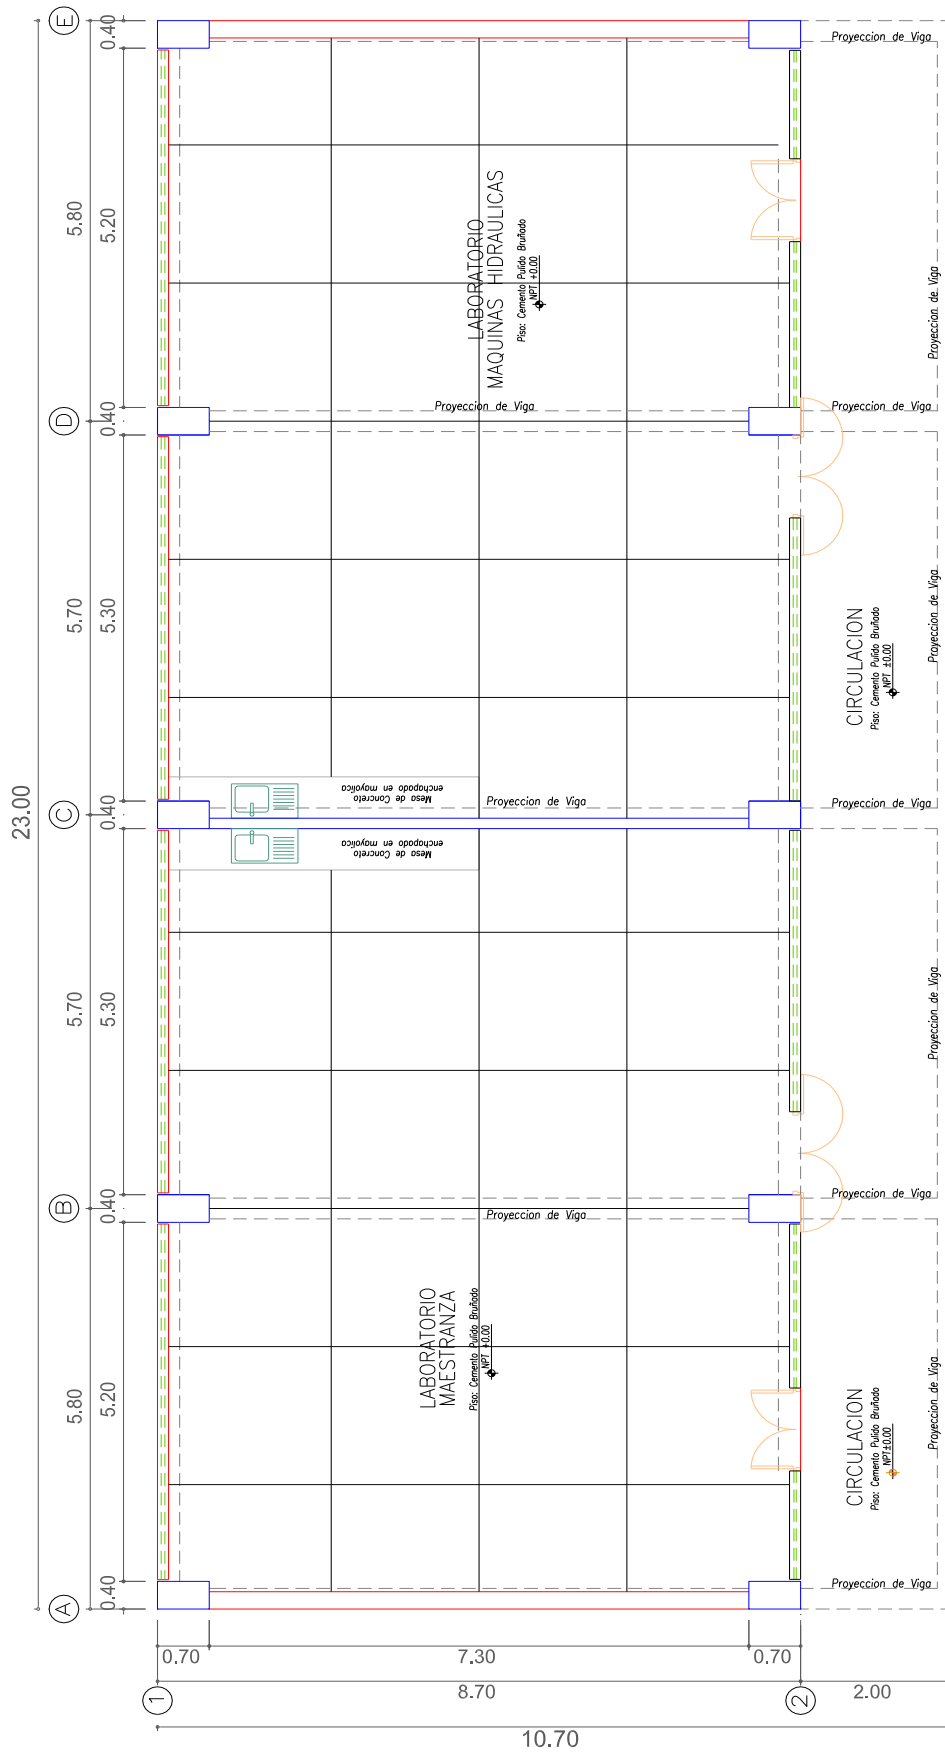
a. Planta arquitectónica primer nivel edificio aislado.
